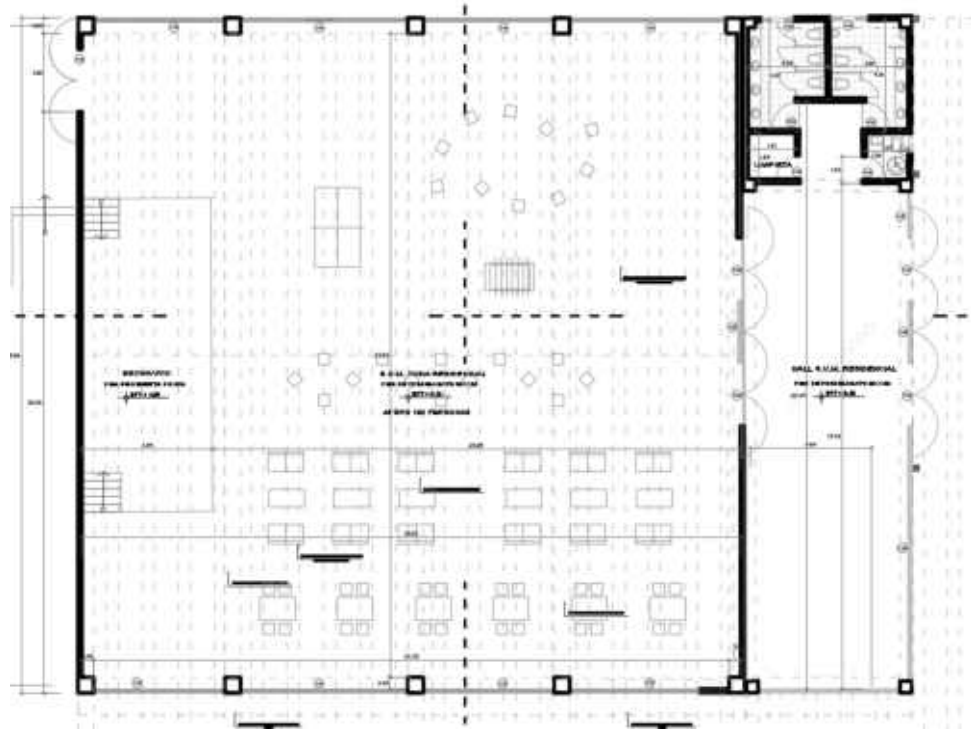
planta secciones y elevaciones de bloque de S.U.M., fuente elaboración propia.
